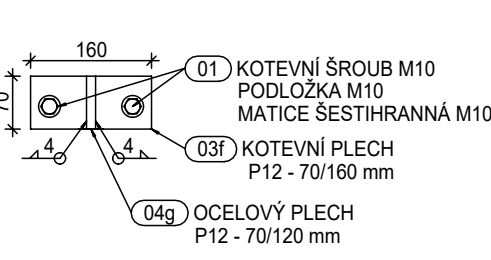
SLOUPEK SCHODIŠTĚ V RAMENI
